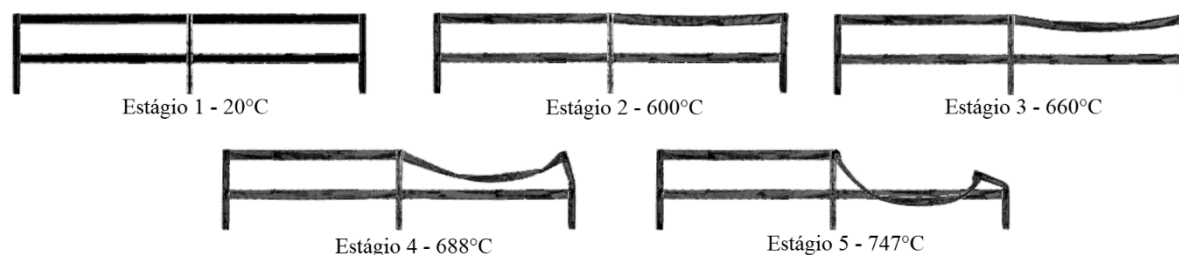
Processo de colapso de pórticos com 15 metros de vão, pilar misto central com vigas e pilares sem revestimento contra o fogo
